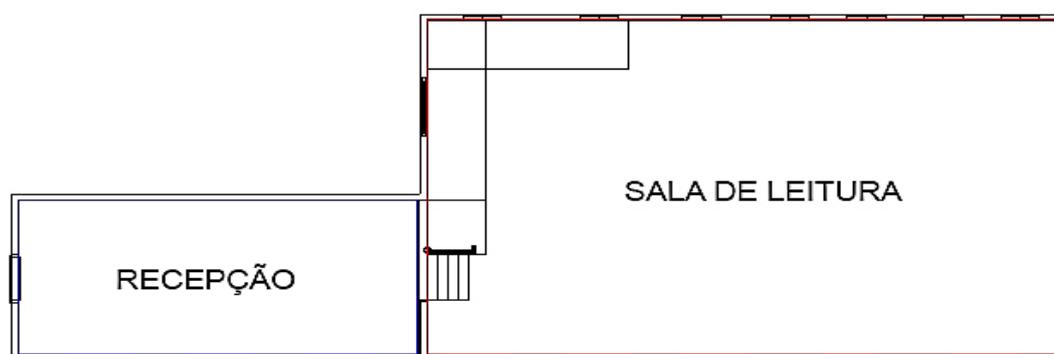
Área interna da biblioteca dividida em recepção e sala de leitura.
